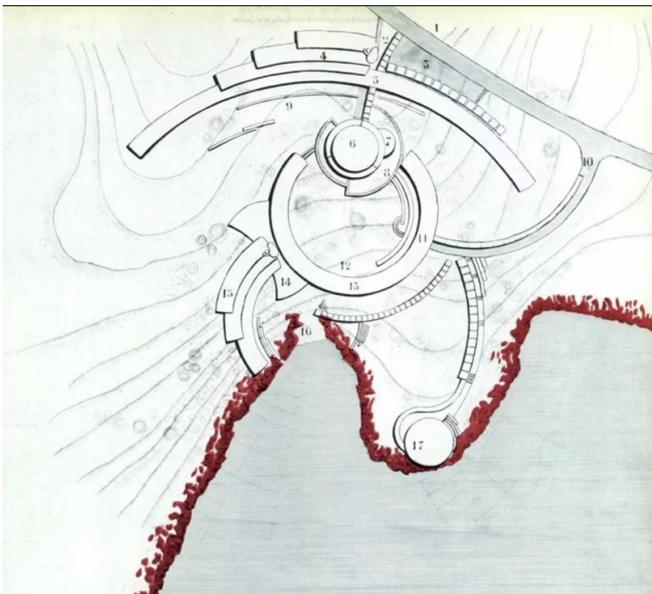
Hotel a Manacore, planimetria. Fonte DomusWeb
